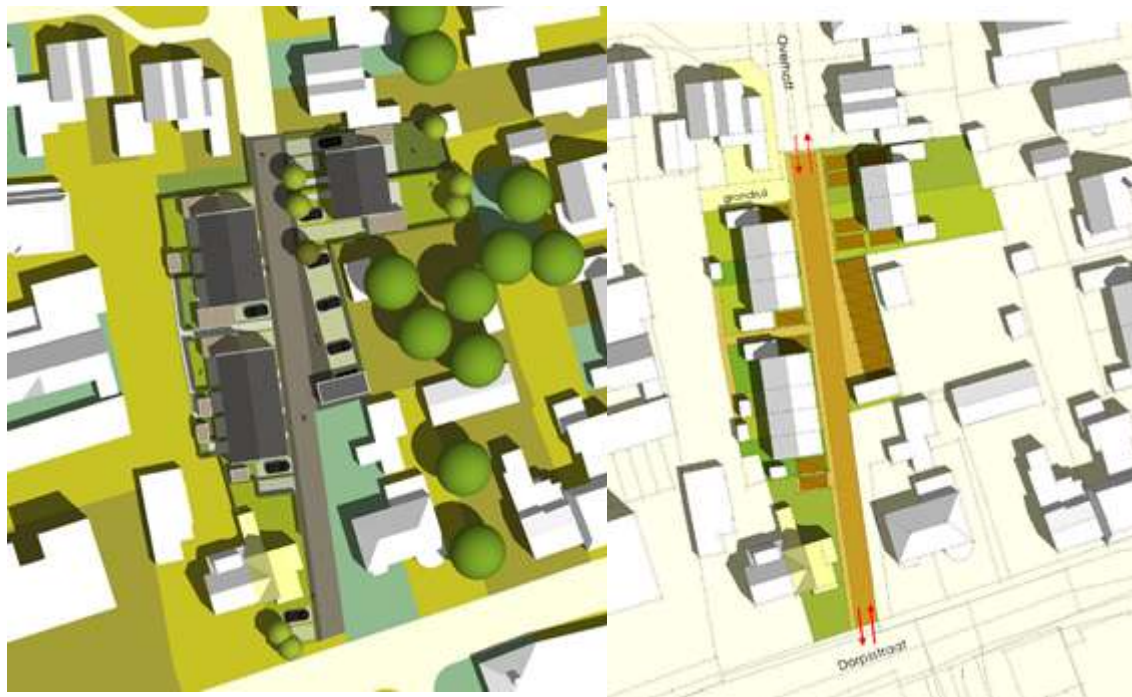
Huidige situatie. De huidige woning (linksboven) blijft behouden. De overige opstallen van het voormalige hoveniersbedrijf worden gesloopt
